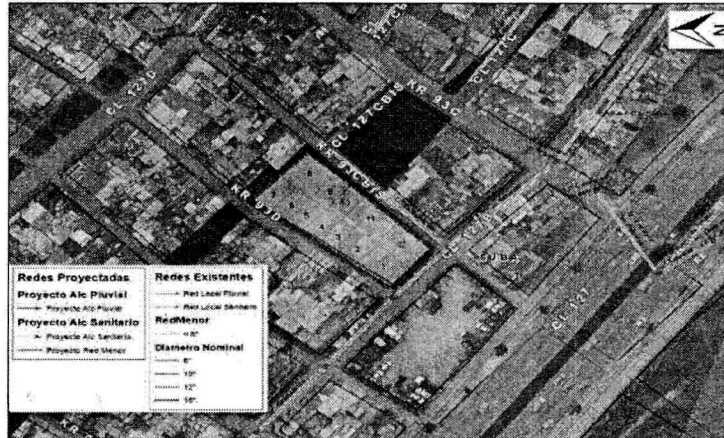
Redes alcantarillado pluvial existentes. Fuente: SIGUE EAAB
